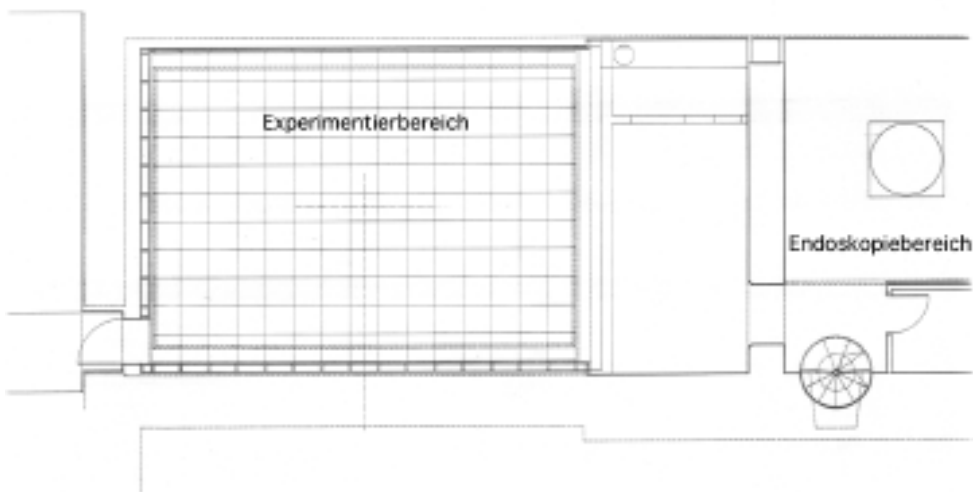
Grundriß des Raumexperimentierlabors (Kellergeschoß).
